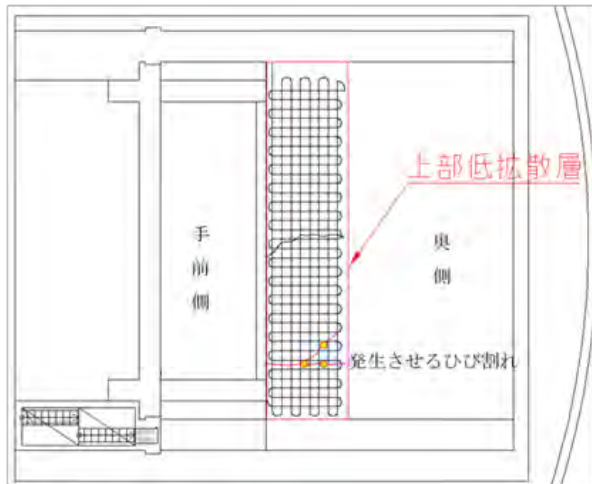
ひび割れ誘発位置（上部低拡散層）
